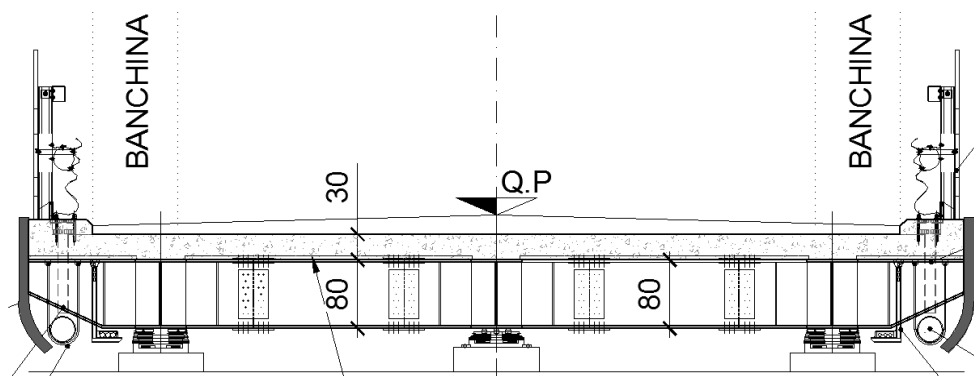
Sezione trasversale dell'impalcato campate laterali
